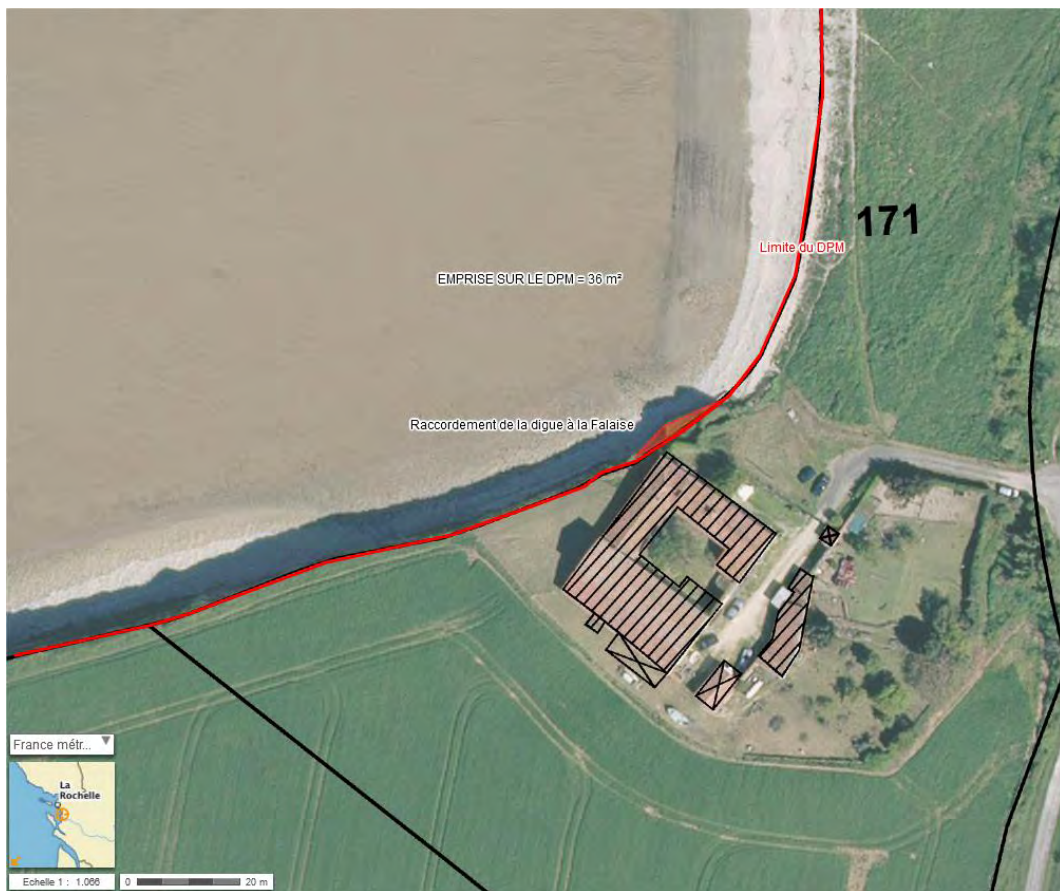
détail des emprises au Sud concernées par la demande de concession d'utilisation du DPM
